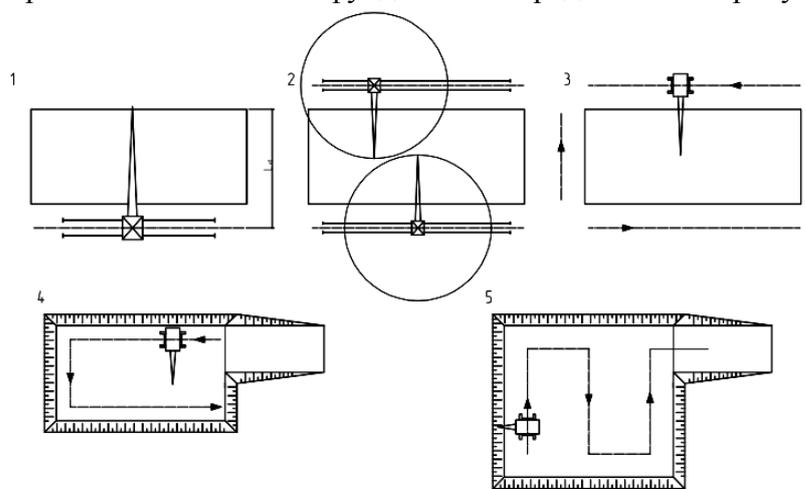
Схема устройства фундаментов многоэтажного здания: по первой и второй схемам фундаменты монтируют башенными кранами или кранами-нулевиками, по третьей, четвертой и пятой схемам фундаменты монтируют самоходными стреловыми кранами
